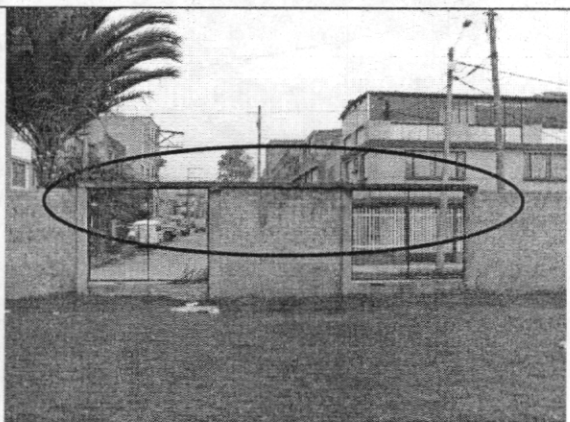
Cinta de amarre, módulos costado calle 24 A sur
